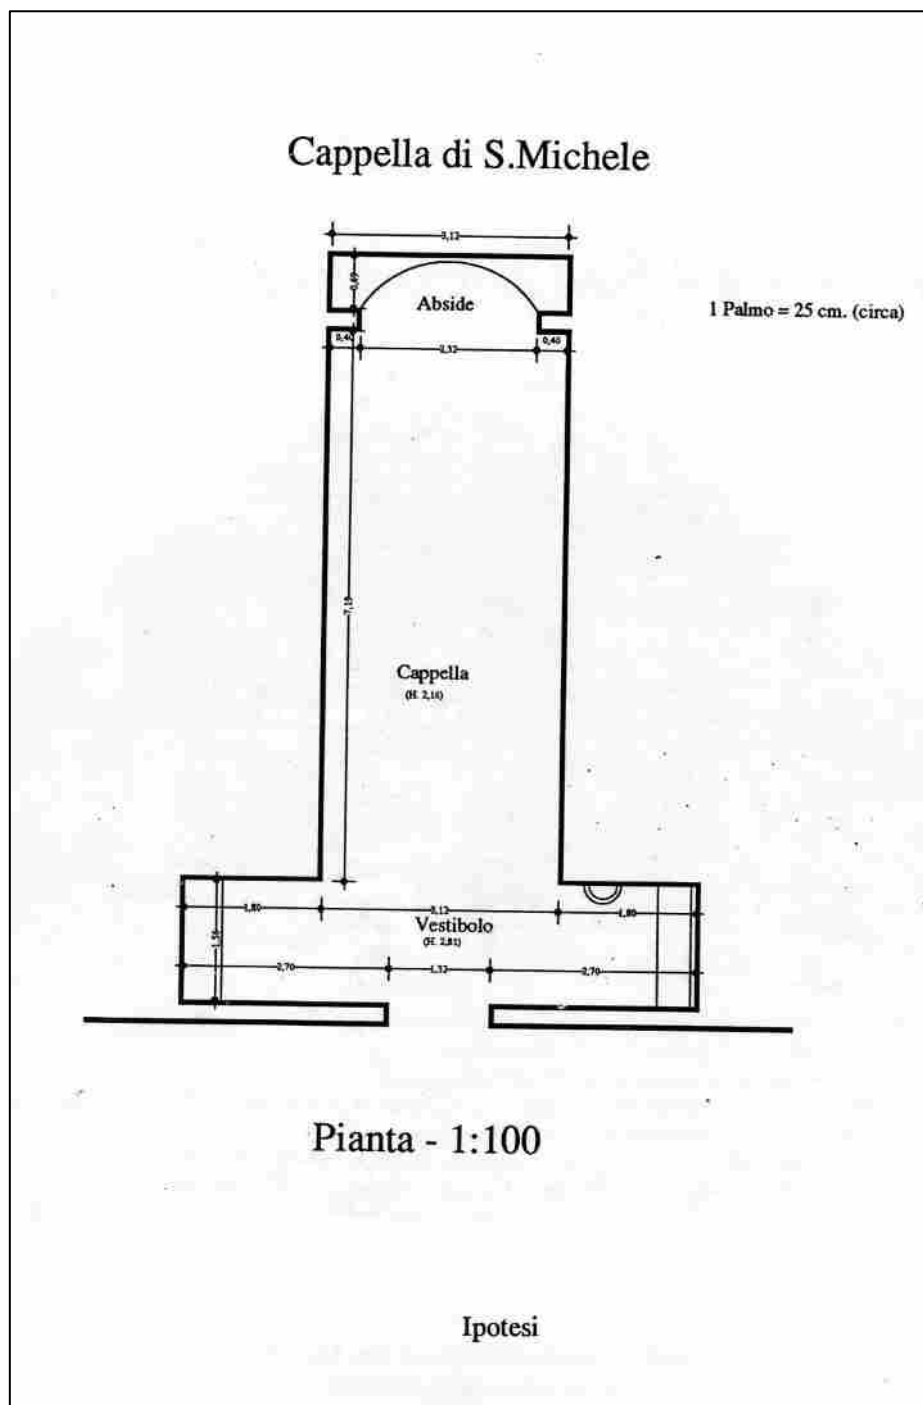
Ricostruzione planimetrica della chiesa con il vestibolo scomparso
